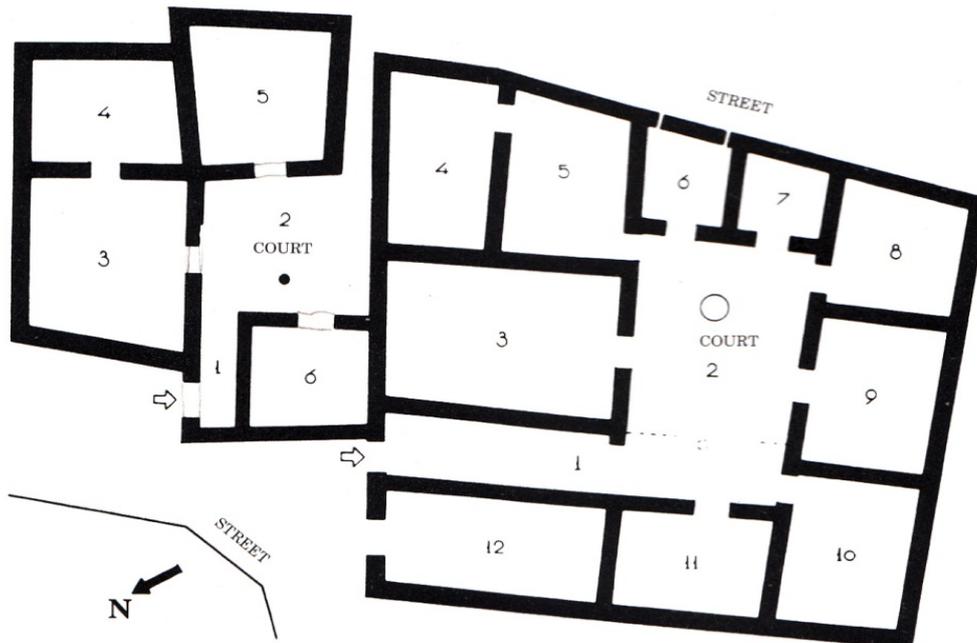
Planta da Casa de Delos-(Capitel,2005)
